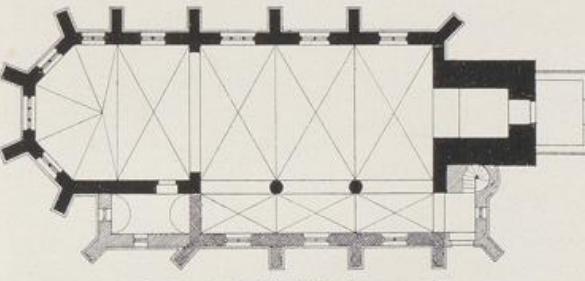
Lamersdorf. Grundriss der kathol. Pfarrkirche.
